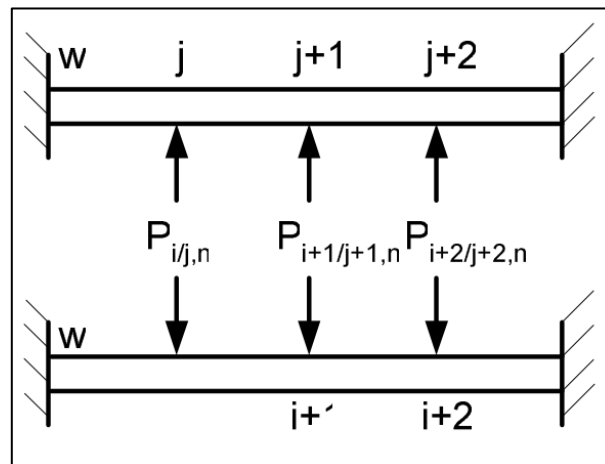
Equilibrio estático de las losas tras el desapuntalado de la planta inferior
